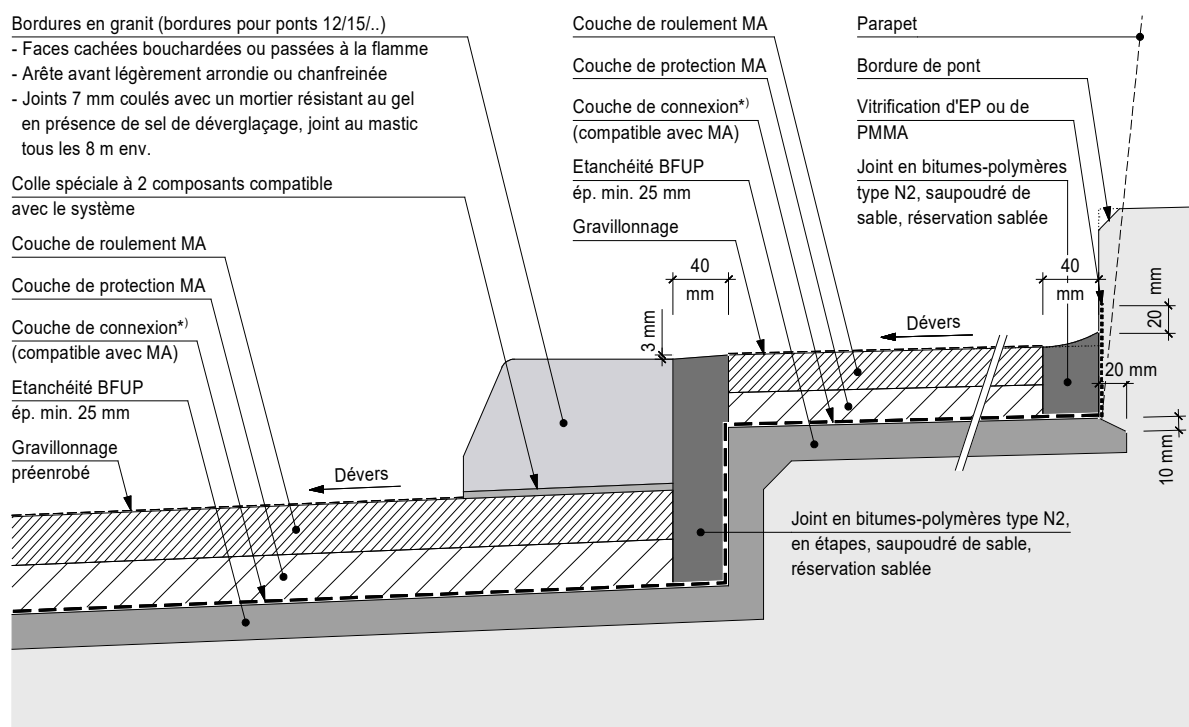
Système d'étanchéité BFUP - Raccord aux trottoirs - Bordure de trottoir collée - Point haut
